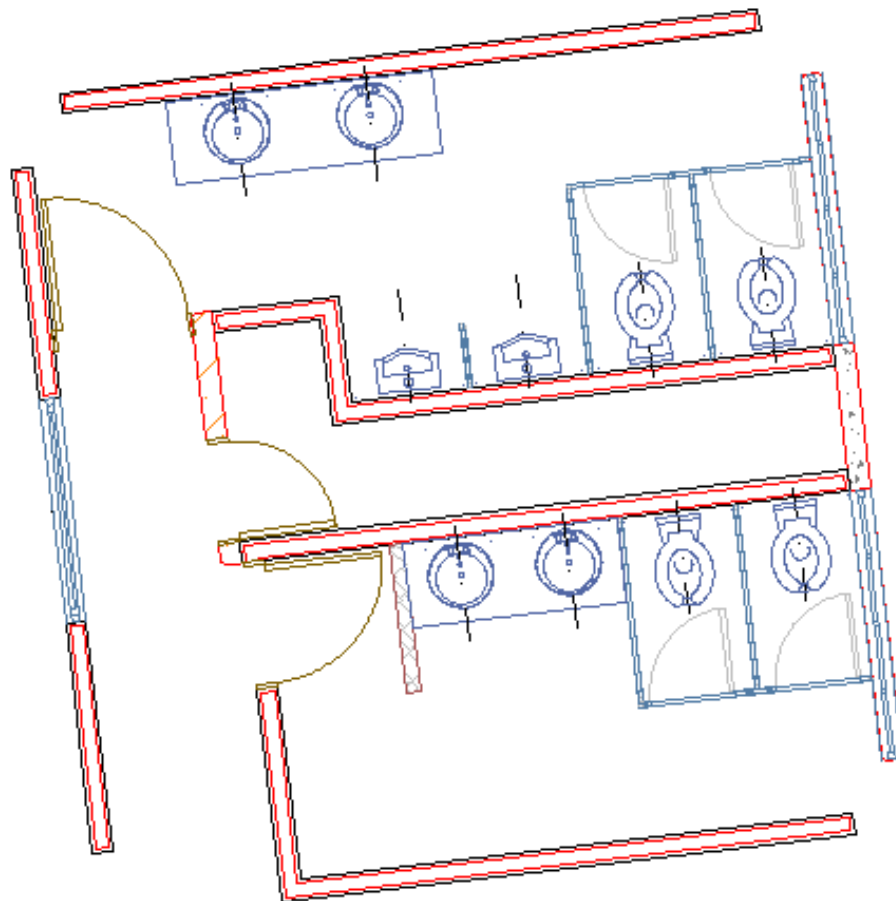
Planta del elemento del módulo de baños de la remodelación Nivel 2
